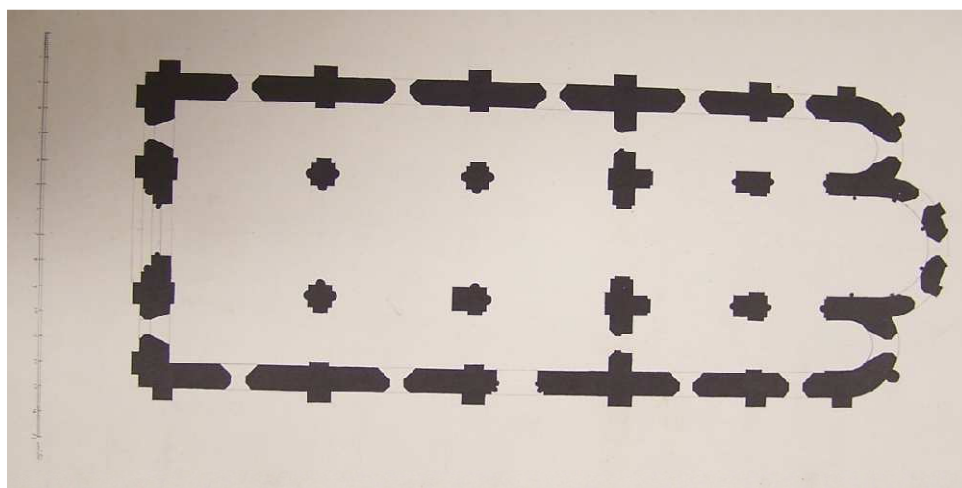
Plan dressé par l'architecte Fléchet en 1845 (MAP – 82/71/2002)
